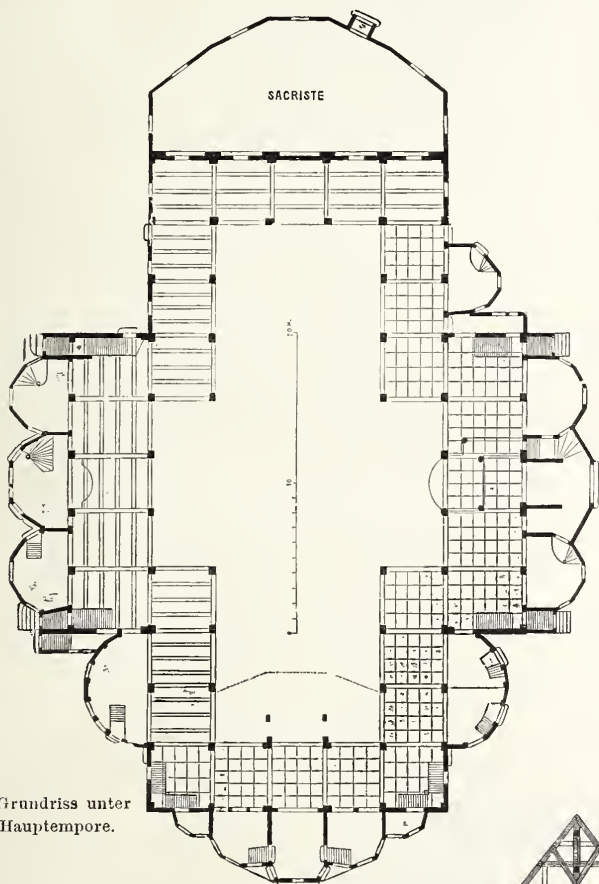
Grundriss unter der I. Hauptempore.
